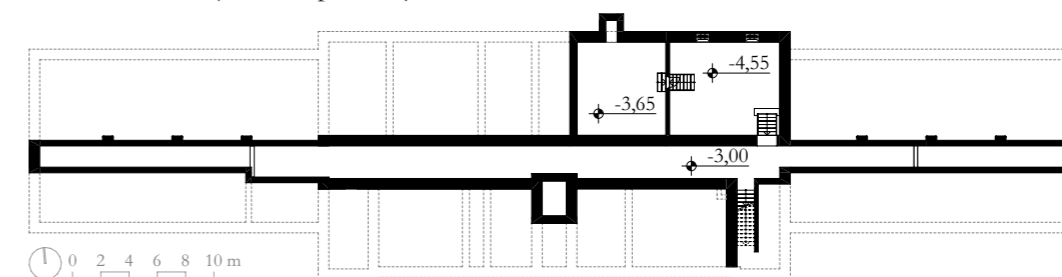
Grundriss Bestand Kellergeschoss M 1:500
